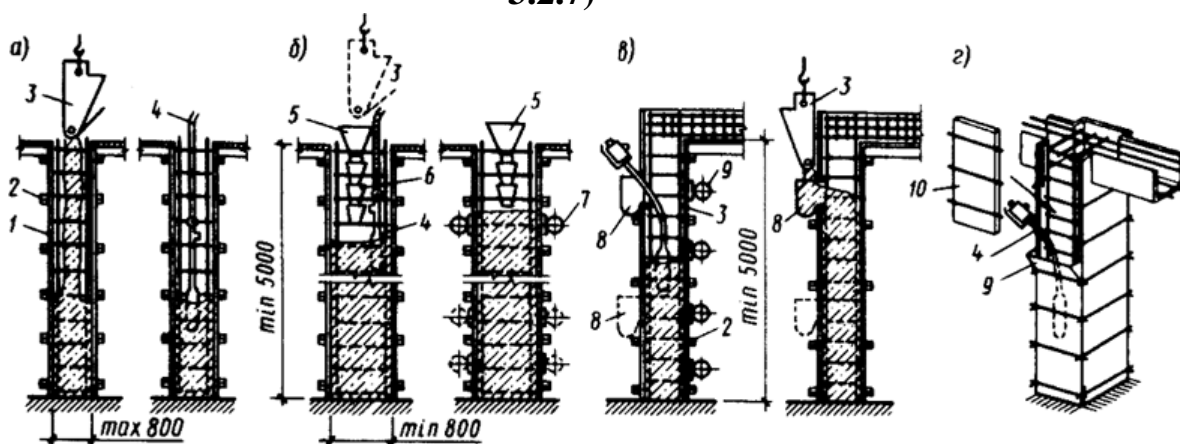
Укладка бетонной смеси в колонны:
